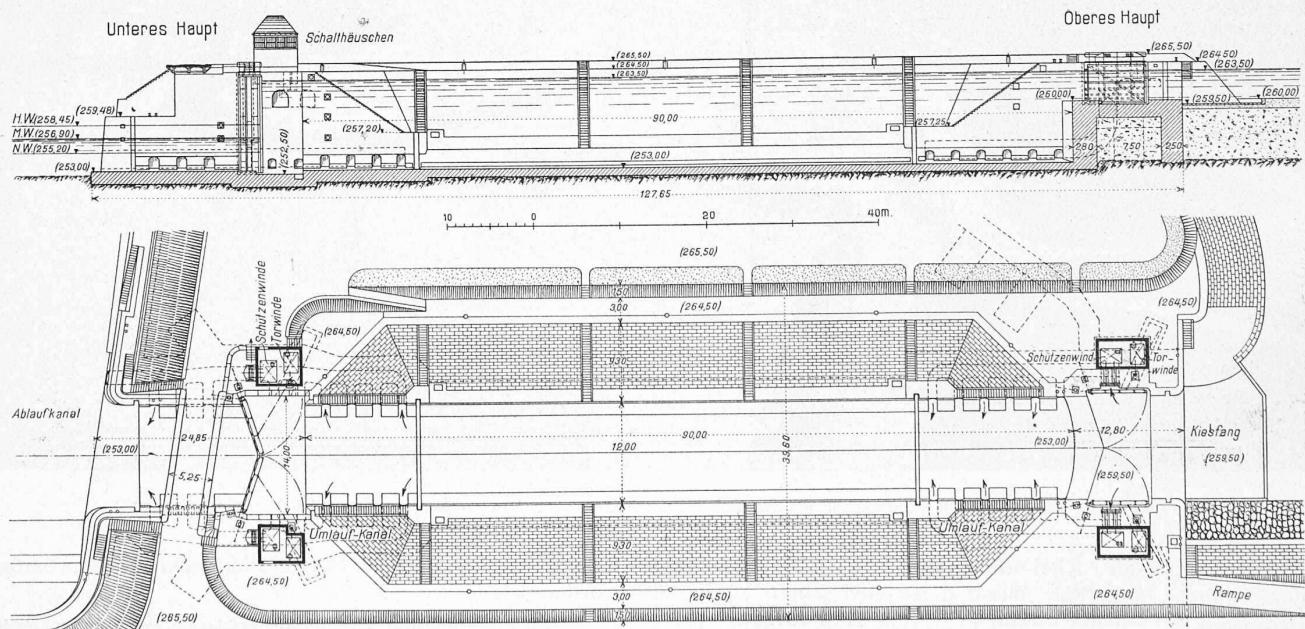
Die Rhein-Grossschiffahrtsschleuse beim Kraftwerk Augst. — Grundriss und Längsschnitt 1 : 800.
